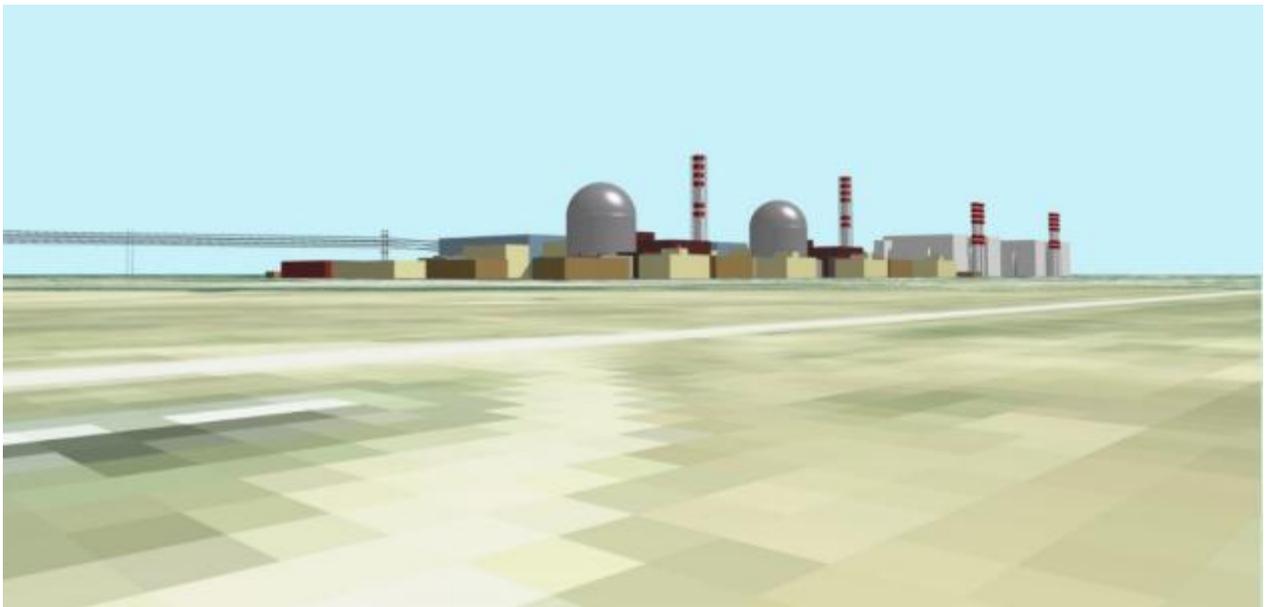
Planirani blokovi i 400 kV dalekovod, u visini očiju – s jugozapada
